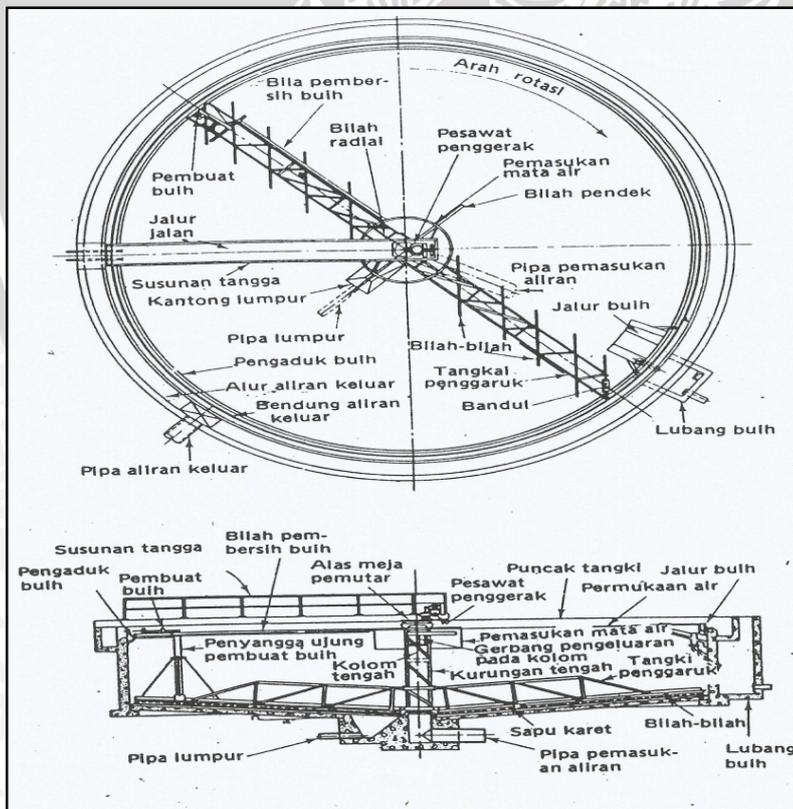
Skema garis edar pengendapan di tangki pengendapan tipe bulat.
